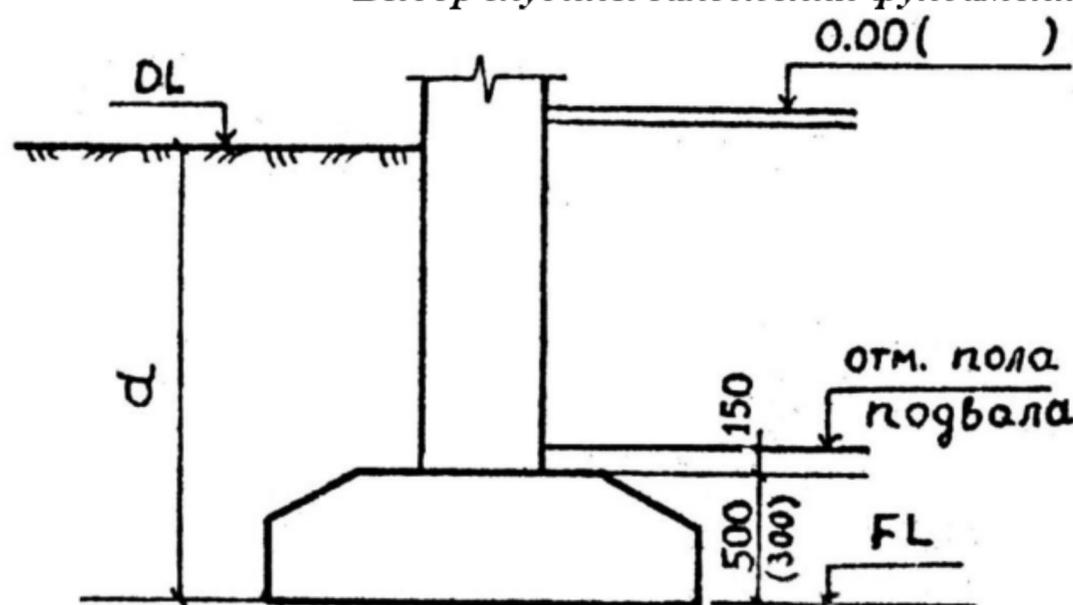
Схема для расчёта глубины заложения подошвы фундамента.
